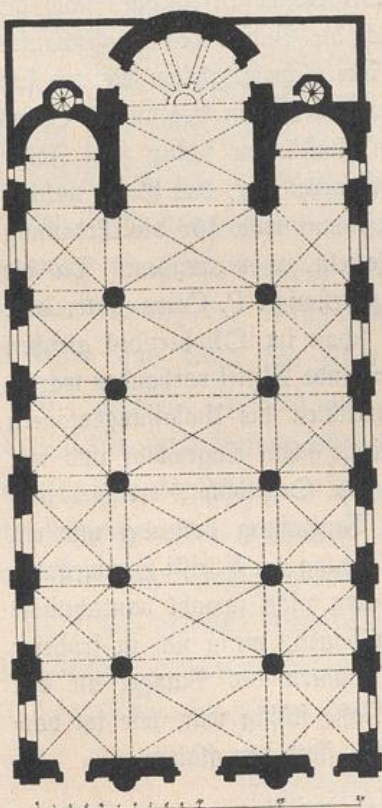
Mecheln. Frühere Jesuitenkirche. Grundriß.
